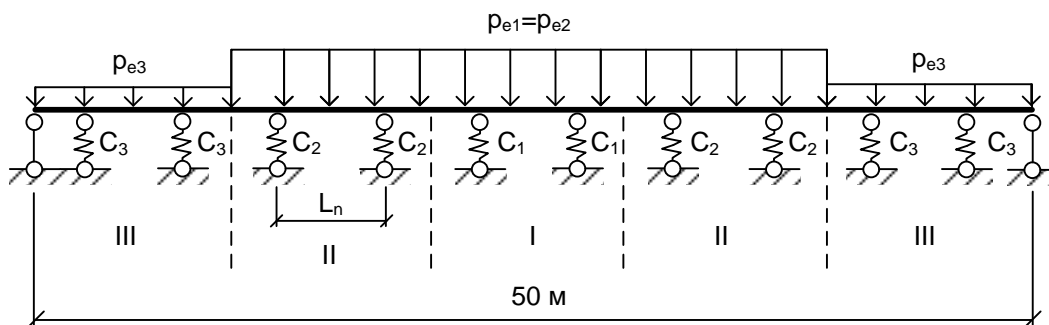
Расчетная схема трубопровода на участке просадки.
